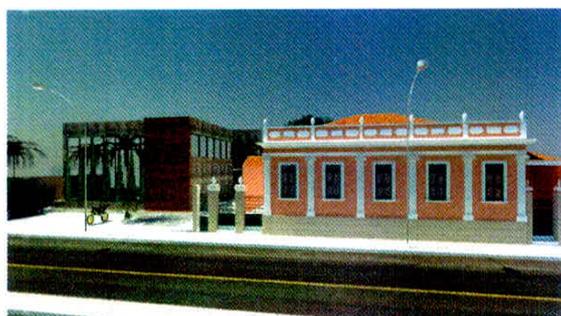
Fachada Frontal (Galeria e Casa da Cultura)
